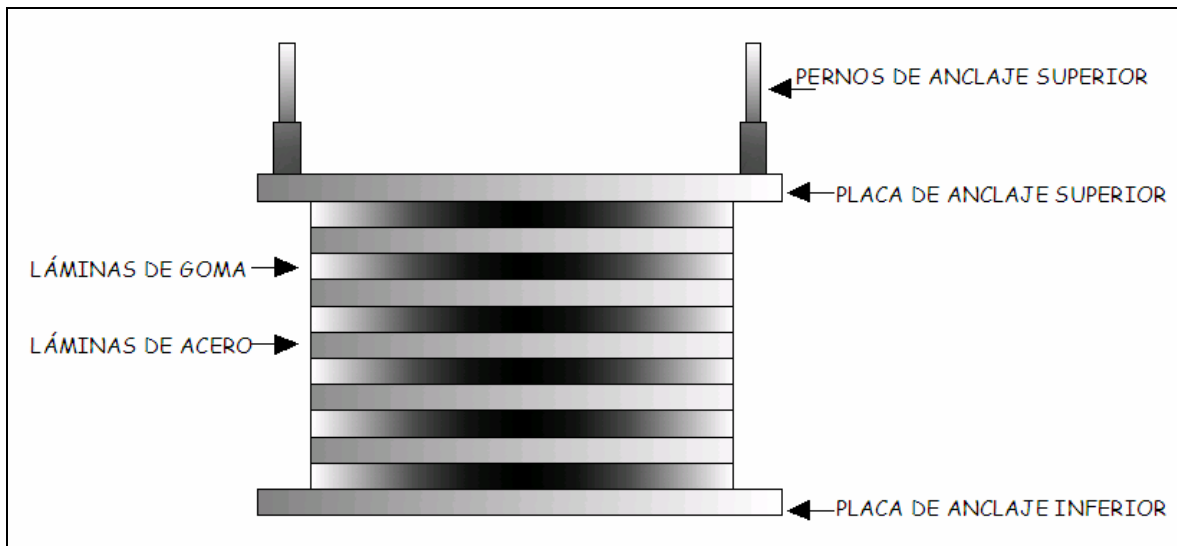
Vista de detalles de un Aislador Elastomérico
